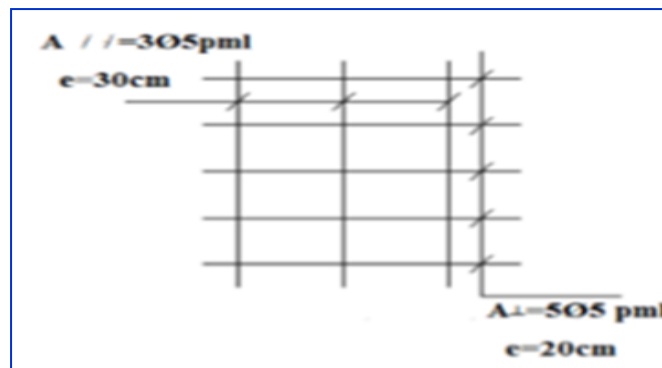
Ferrailage de la dalle mince (Treillis soudée)
